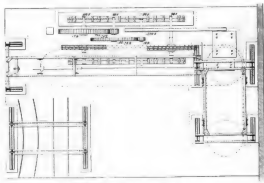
Z. A. Details maschineller Seil- und Kettenförderungen.
